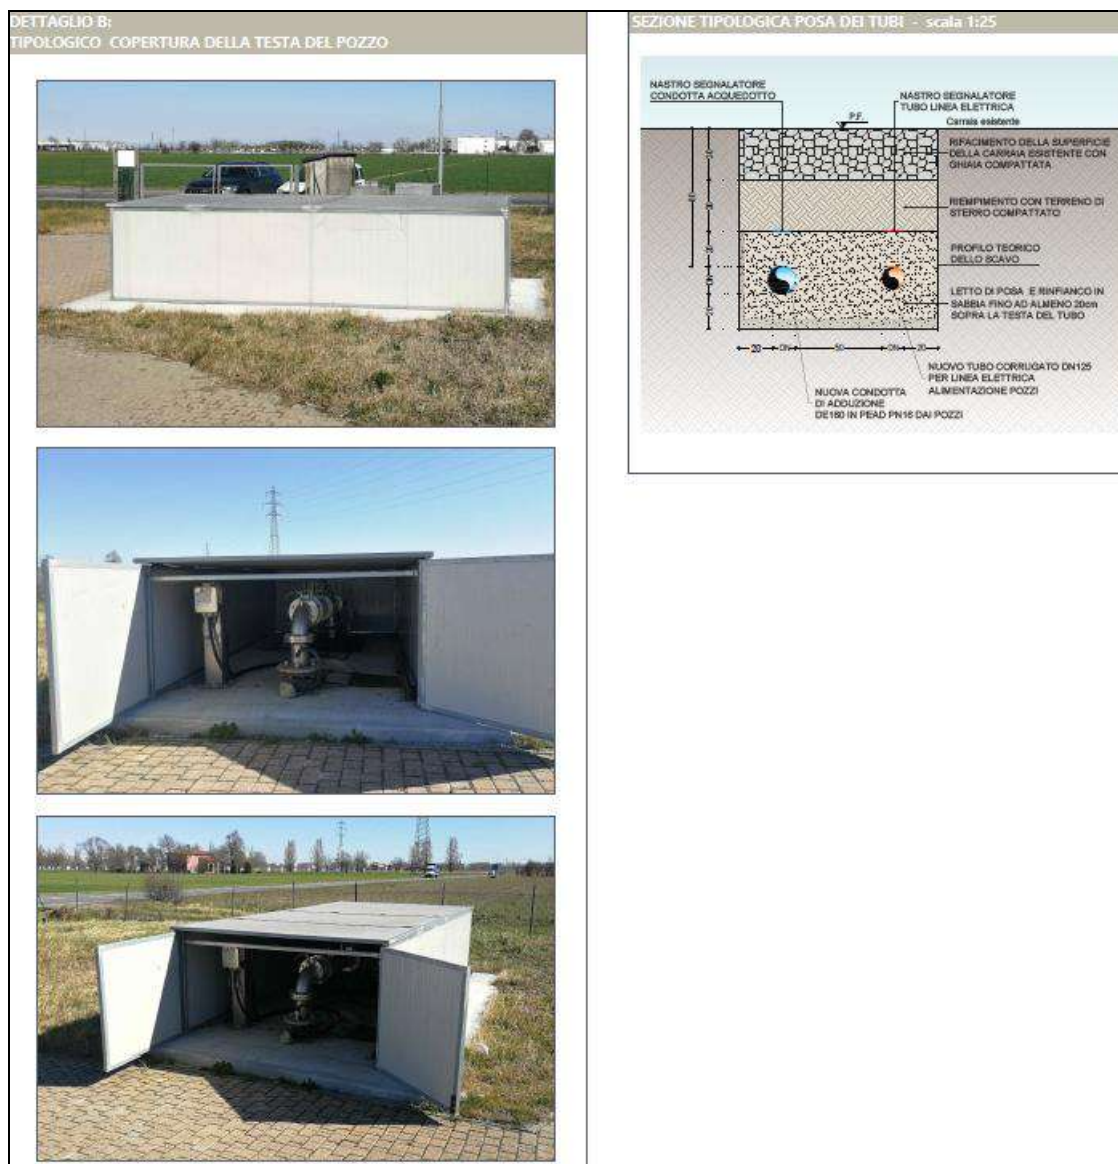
Schema di progetto copertura testa pozzo dei pozzi Vignale 1 e 2
